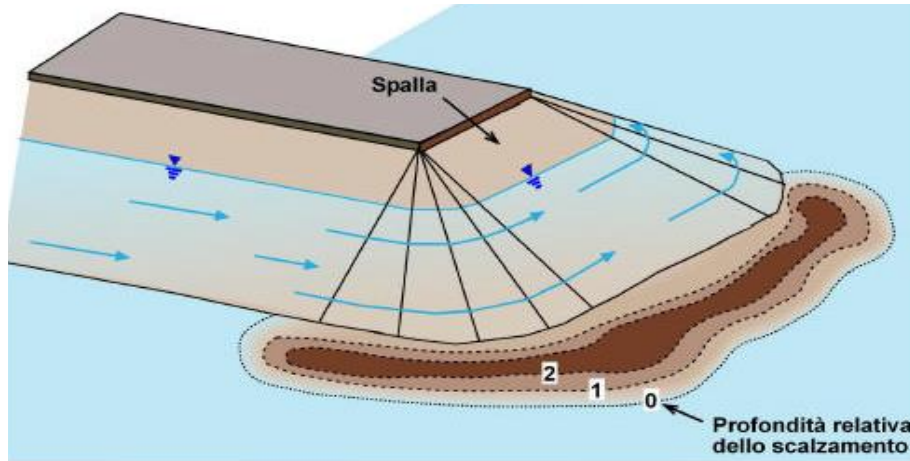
rappresentazione schematica del campo di moto e del processo di escavazione localizzata in corrispondenza della spalla di un ponte
